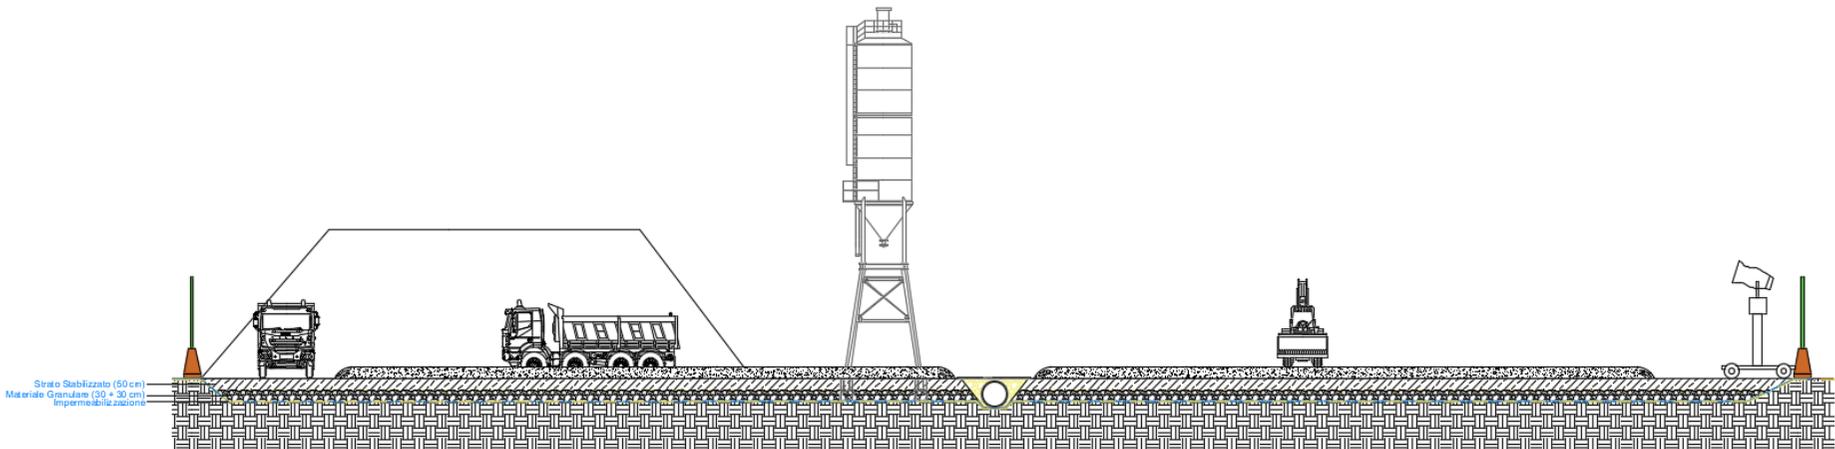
Sezioni dei campi di stabilizzazione 1 e 2
